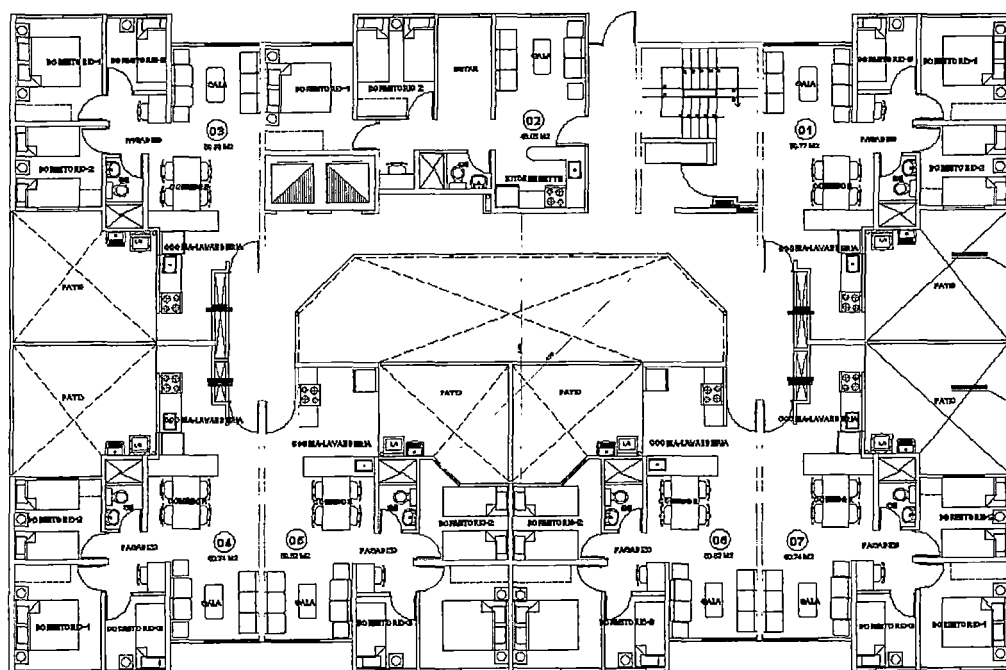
Planta típica Techo Propio con 7 departamentos/piso (De la Piedra Consultores)
